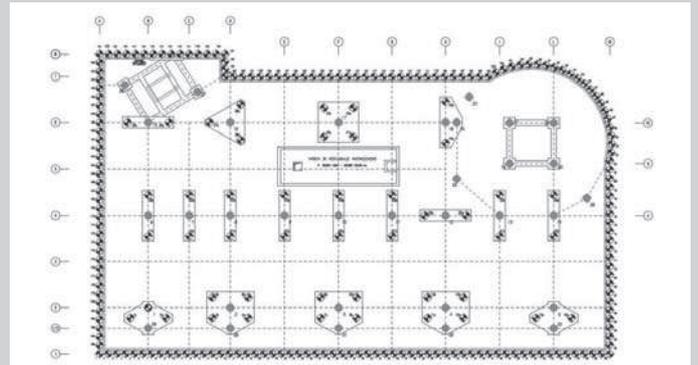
pianta della fondazione: i pali "colonna" retinati collegati ai pali "satellite" con i plinti
